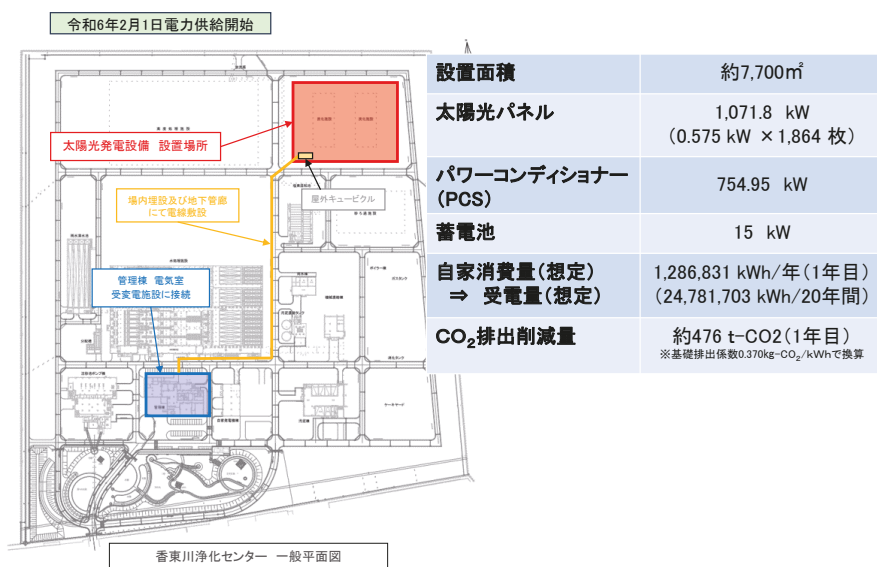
太陽光発電設備等の設置概要（香東川浄化センター平面図）
